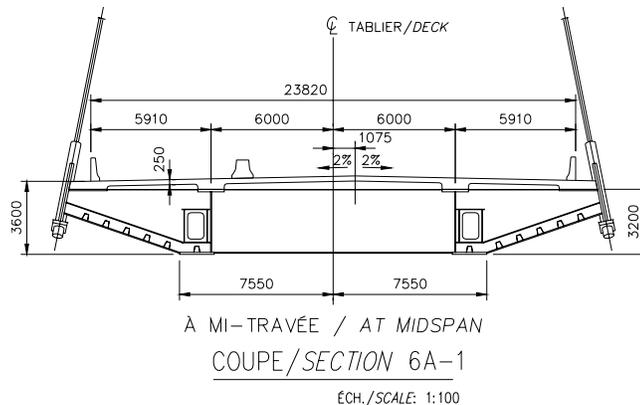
Coupe transversale – Pont à haubans – Solution bipoutres
